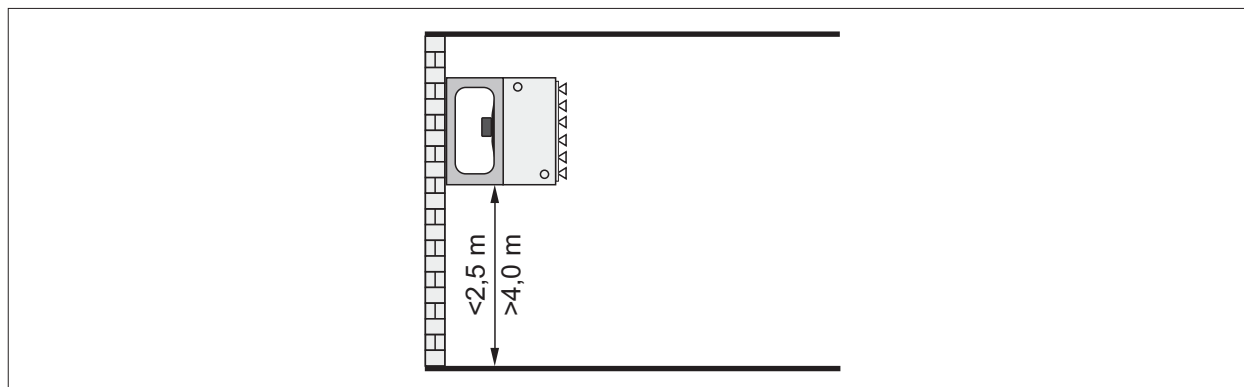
Монтажная высота при настенном монтаже, направление воздуха горизонтальное
